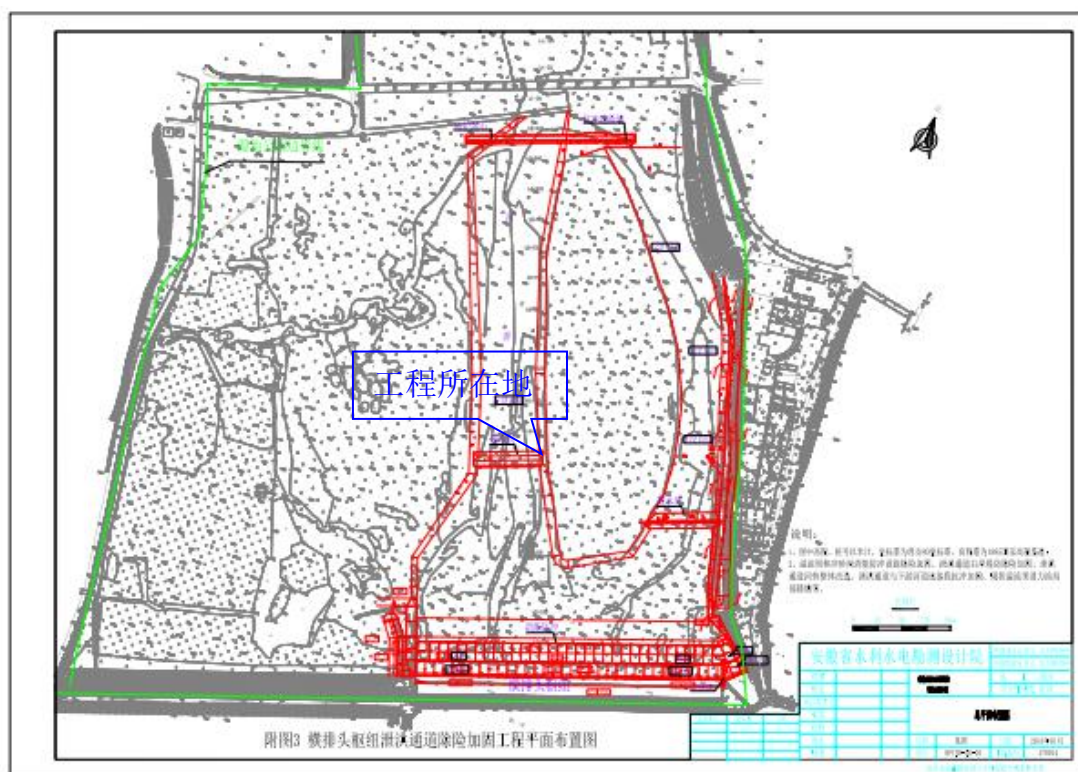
横排头枢纽泄洪通道除险加固工程平面布置图
